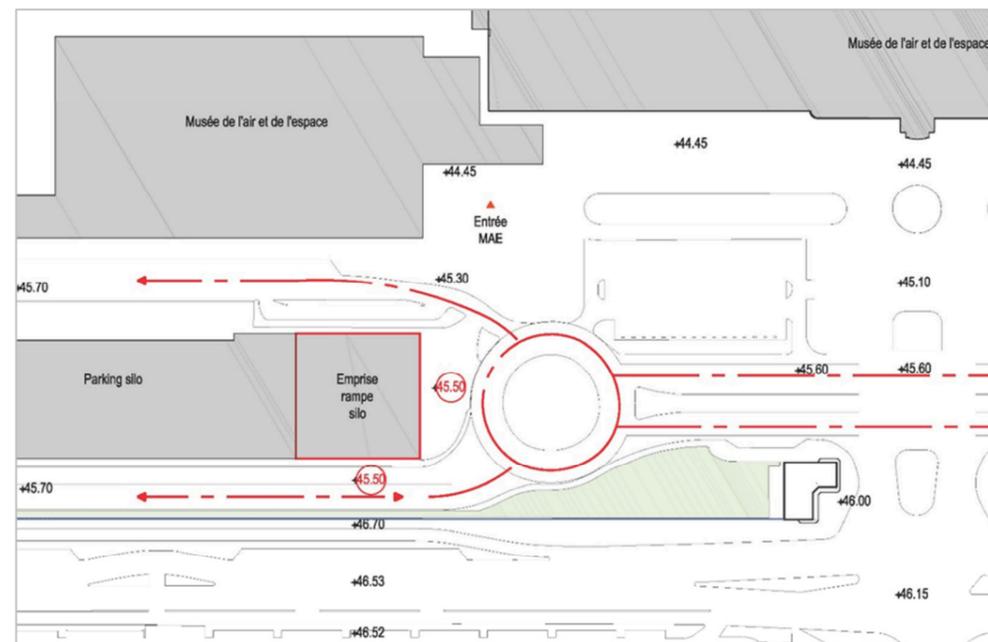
Nivellement existant du site d'implantation de la gare LBA
